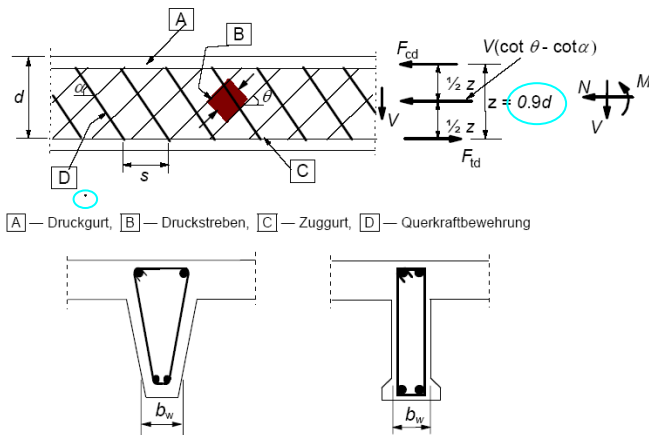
Fachwerkmodell und Formelzeichen für Bauteile mit Querkraftbewehrung
